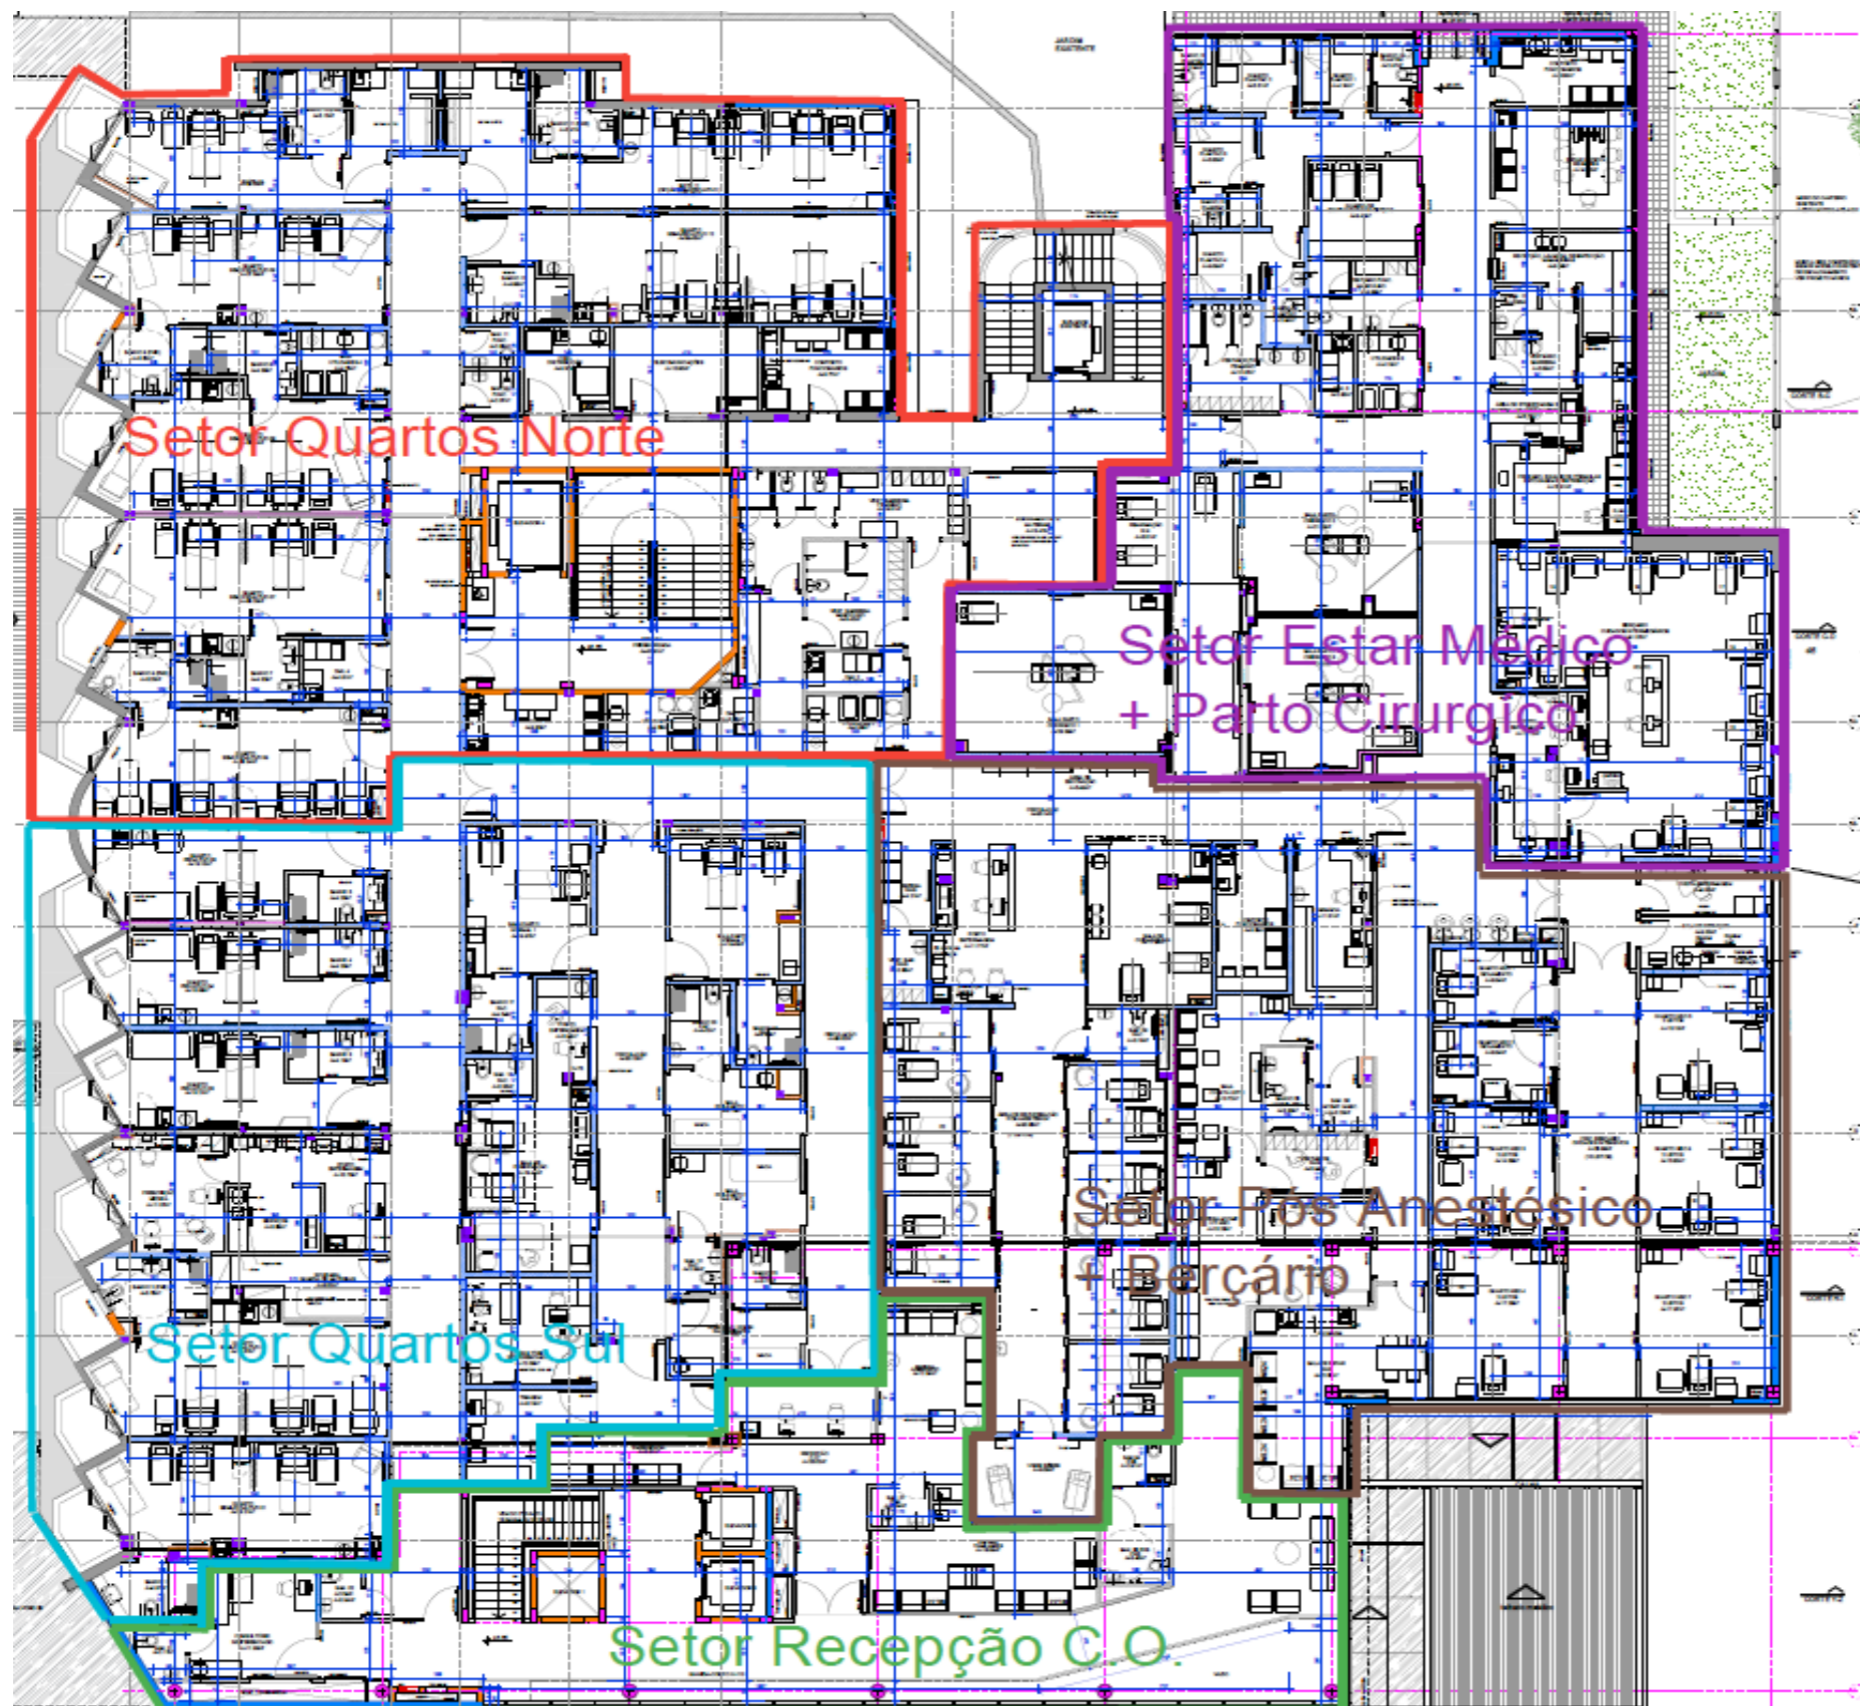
Novas Zonas de trabalho – Terceiro pavimento.
